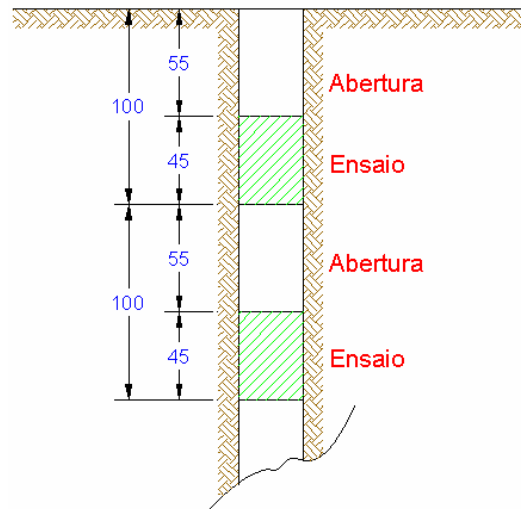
Esquema de elaboração do ensaio SPT.
